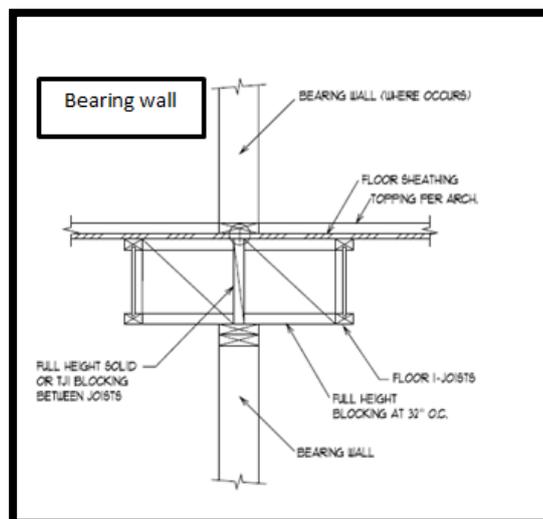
Detalle de muro portante. Fuente: Structural Plans “Providence Hall High School”.
